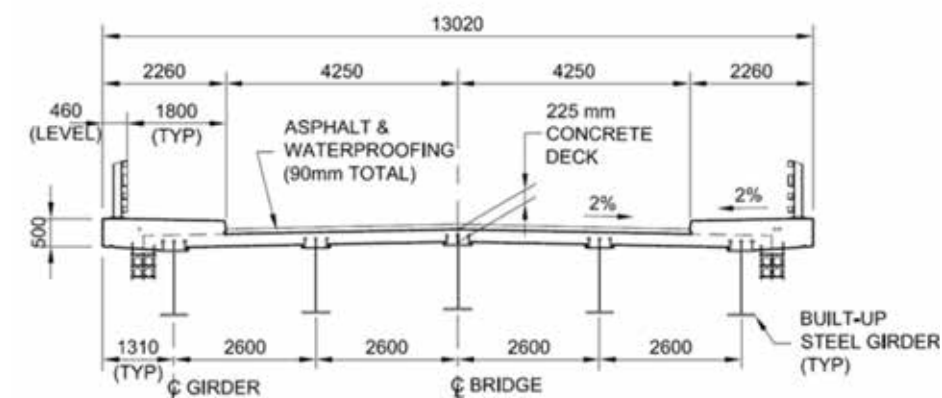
Poutres à âme pleine en acier pour les travées d'approche
